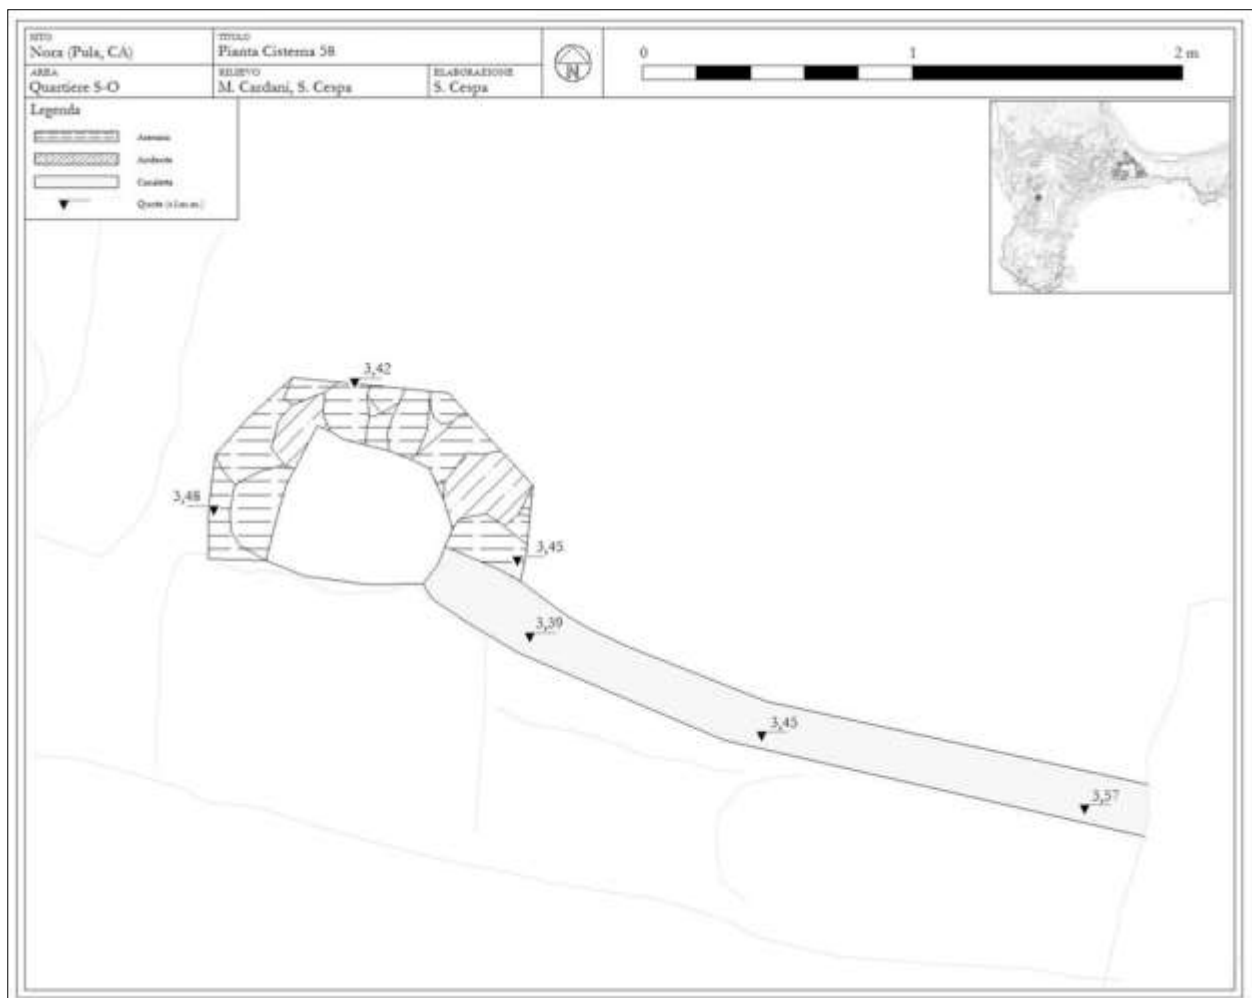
Pianta del pozzo/cisterna 58 (elaborazione dell'autore).
